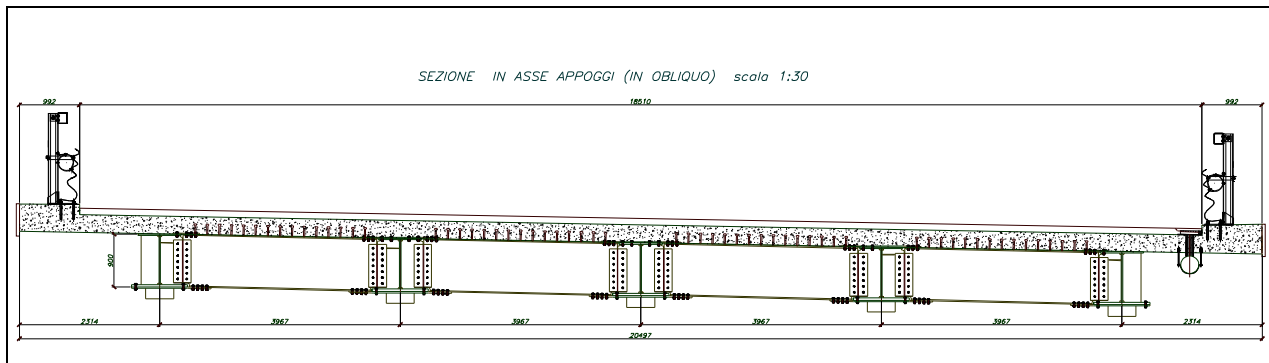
Sezione tipo dell'impalcato Ponte Scolo Galvino
